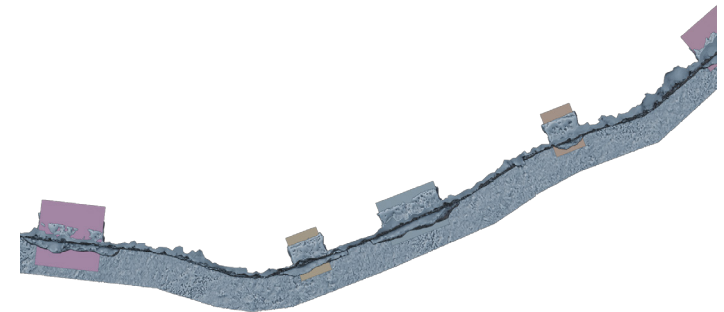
Edición de puertas y ventanas con Booleanas. Vista en planta Fuente: Elaboración propia
